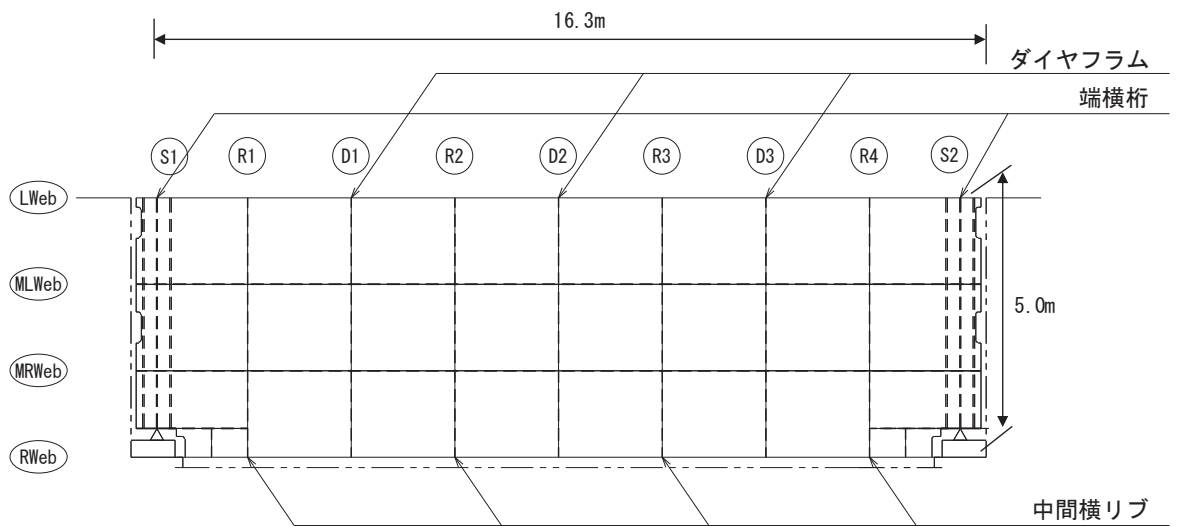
(2) 鋼製遮水壁 (鋼桁 5) 平面図
